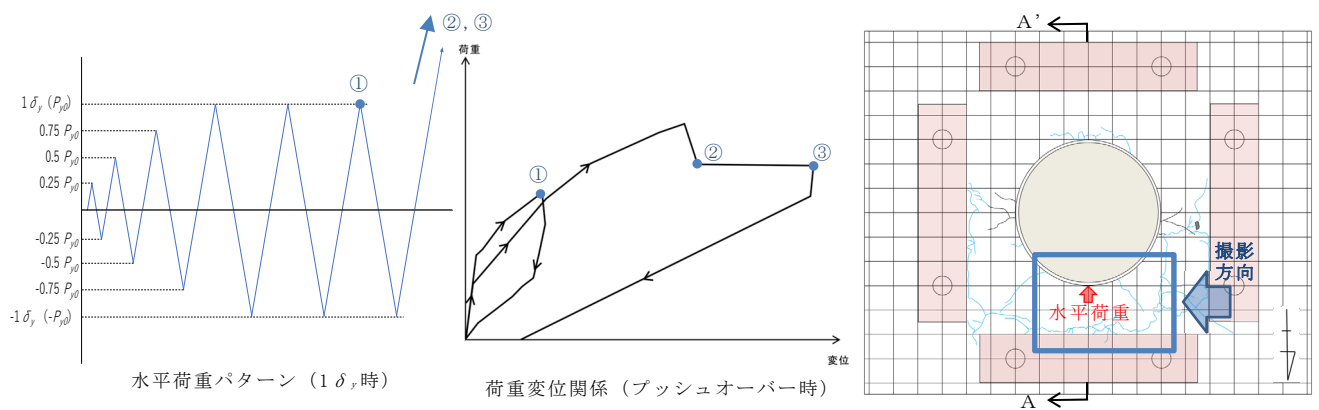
杭頭内部のひび割れ状況図
